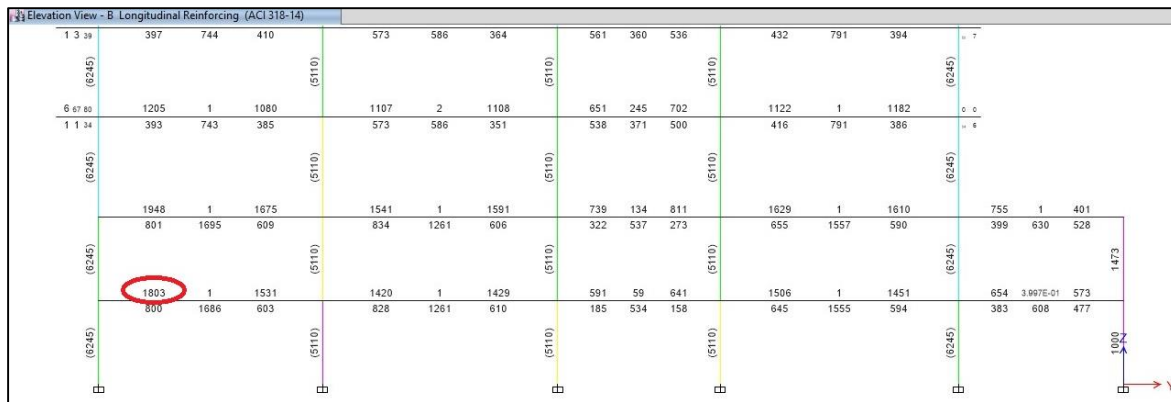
Diseño de secciones de concreto reforzado, acero de refuerzo (mm²), viga B entre el eje 6 y 5 acero de refuerzo solicitado por el modelo 1803mm².
